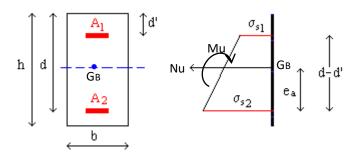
Flexion composée, section rectangulaire et N effort de traction.
